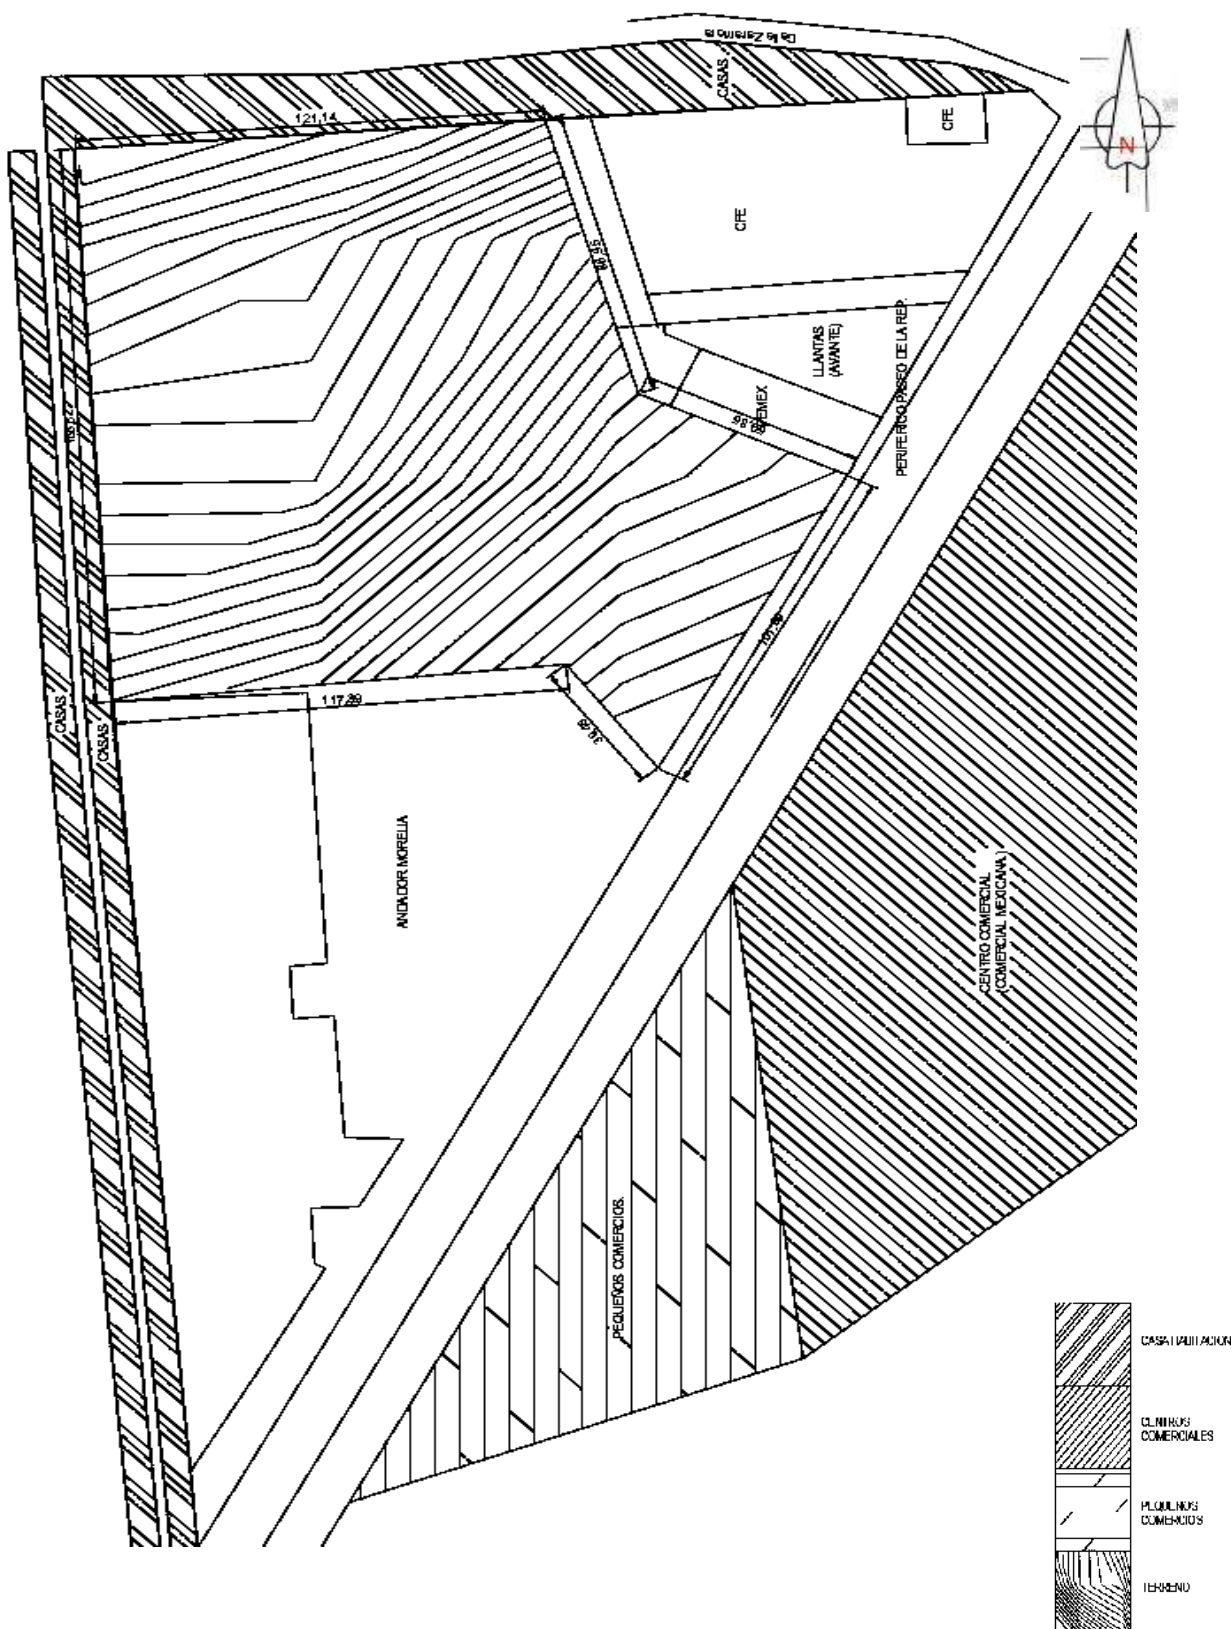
Plano del terreno, donde se incluye las colindantes. Fuente. Fernanda Álvarez Ponce de León. [29/11/2016]
